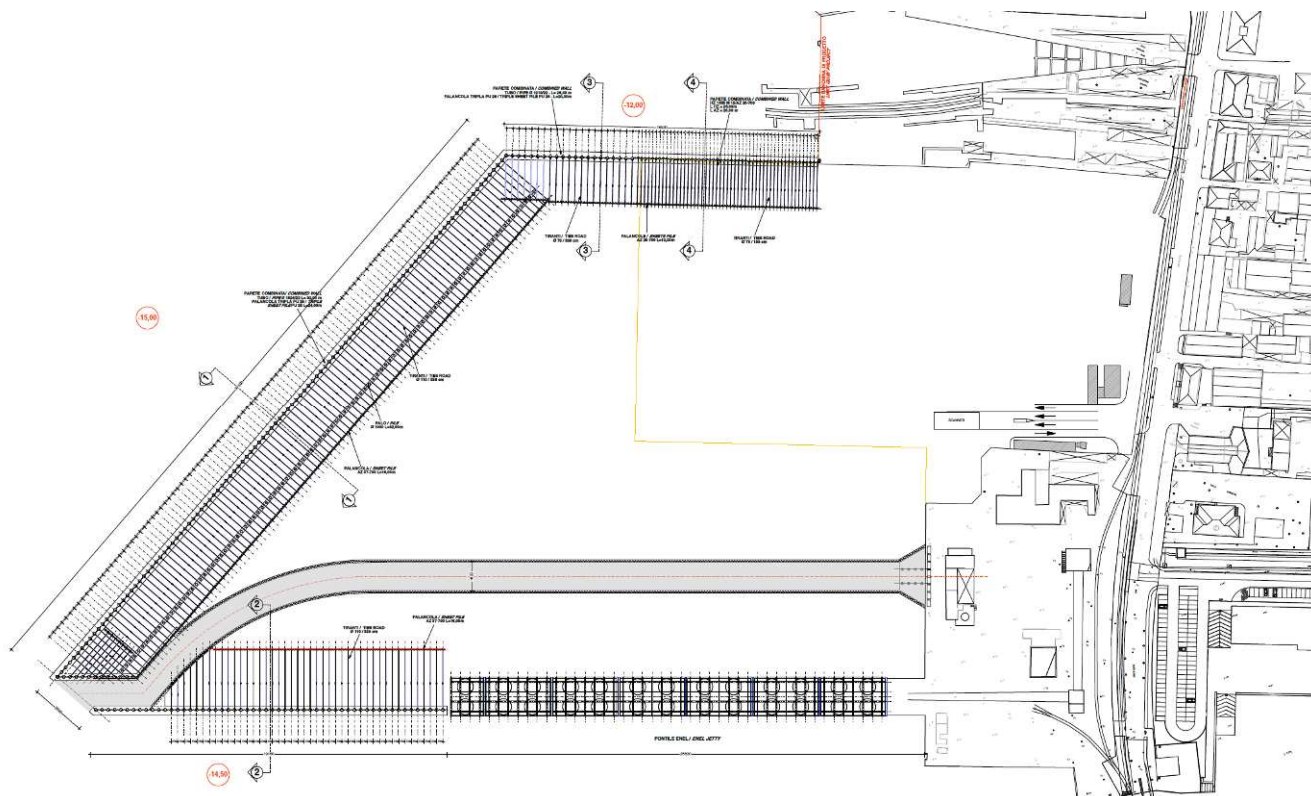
planimetria dell'intervento a livello delle palancole
